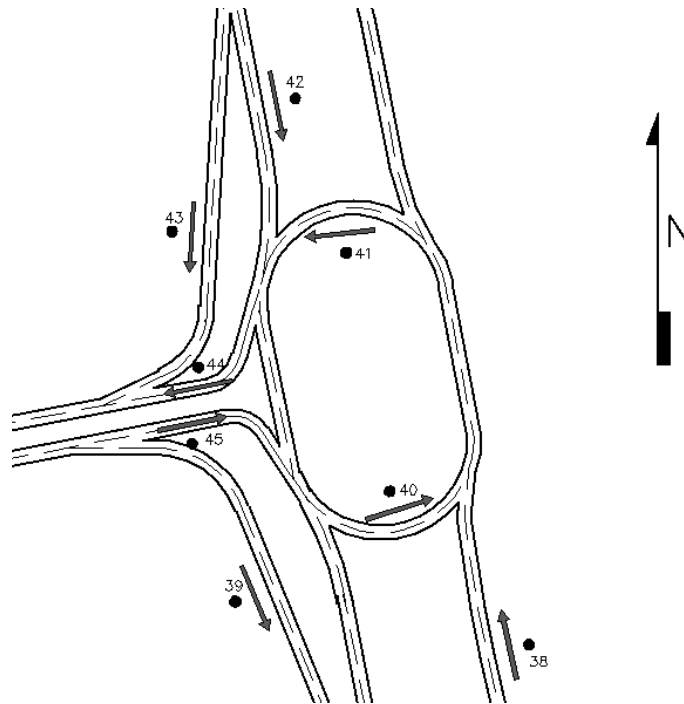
Croqui da distribuição dos pontos levantados na interseção
